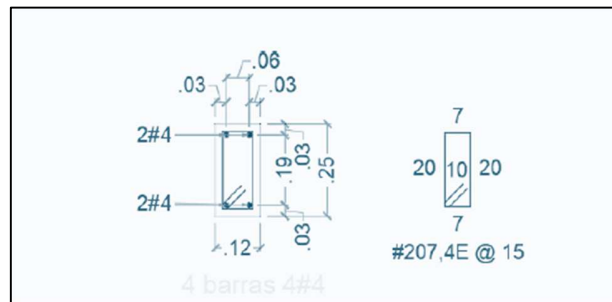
Acero de diseño de vigas Cubierta (VI\_12CMX25CM). Sector entre ejes A-D y 5-14.
